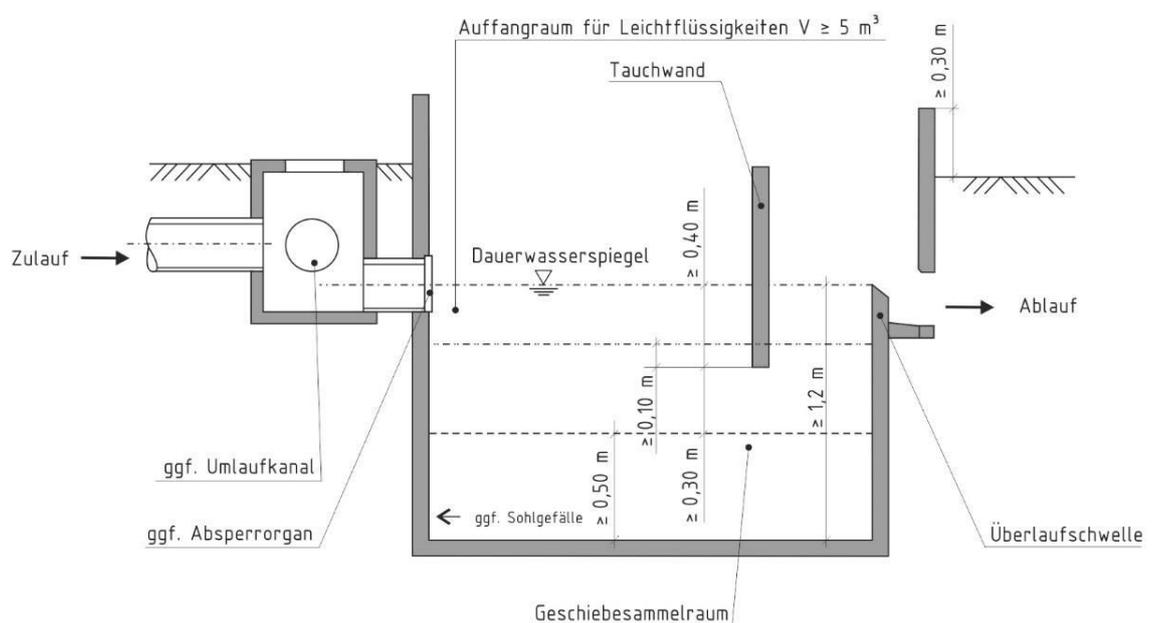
Geschiebeschacht RBF (Auszug Entwurf REwS Bild 68 Geschiebeschacht)
